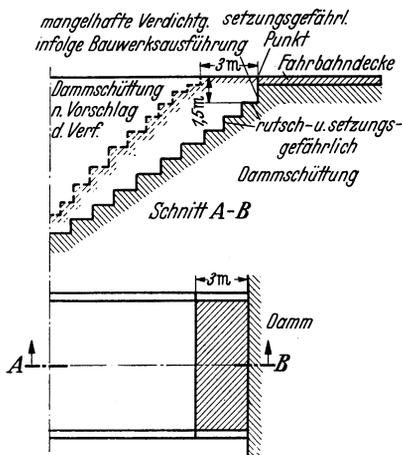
Zweckmäßiger Einbau der Massen und Ausbildung der Decke bei Verdichtung der Massen an aufgelösten Widerlagern (15.)
